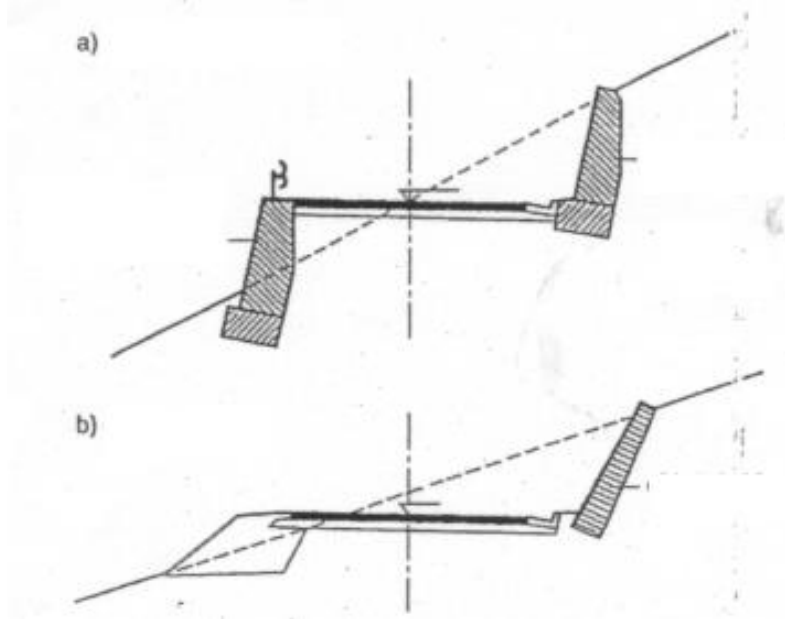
Pozita dhe pamja e disa mureve prej betoni
